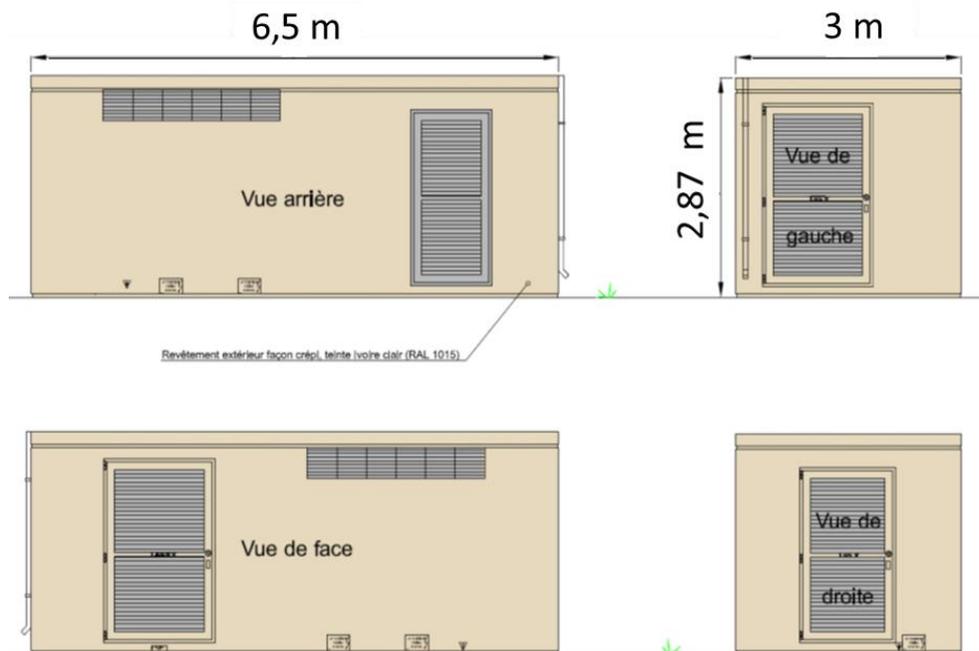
Plan des façades et toiture du poste de livraison et de transformation du projet (source : Valeco)
